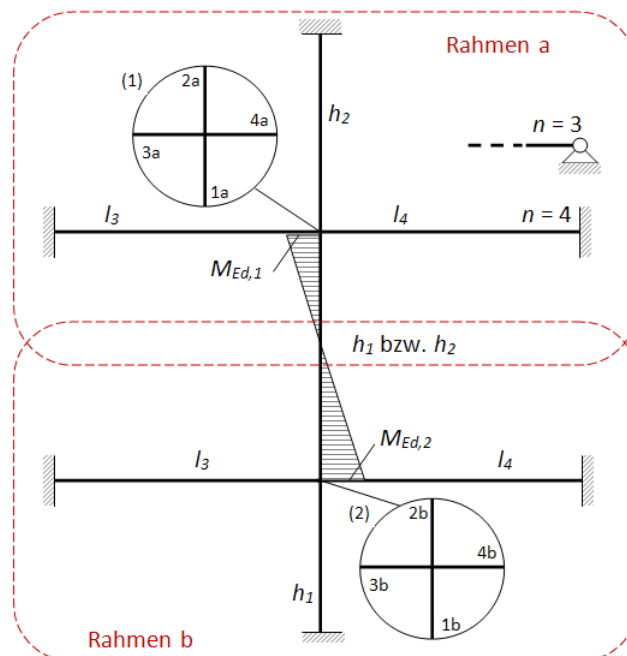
Ermittlung der Knotenmomente mit Hilfe des vereinfachten Rahmenmodells
